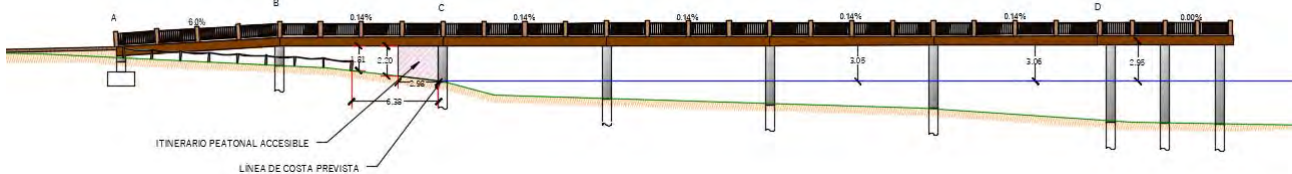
Captura del Plano 02 Planta Alternativa 2 (Anexo 1 Planos).
